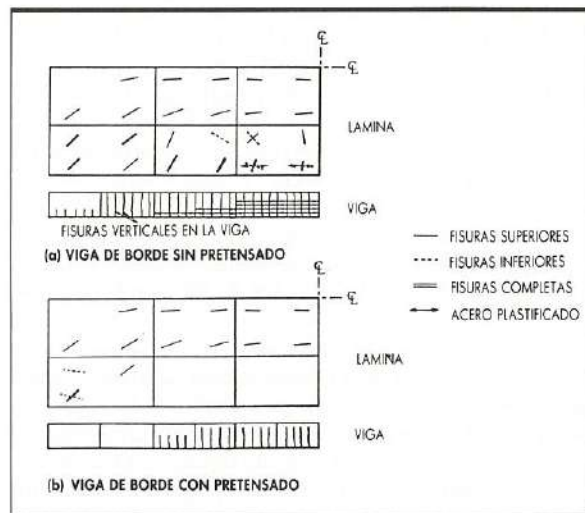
EJEMPLO 1. Modelos de fisuras en la lámina y las vigas, con y sin pretensado en viga de borde.
